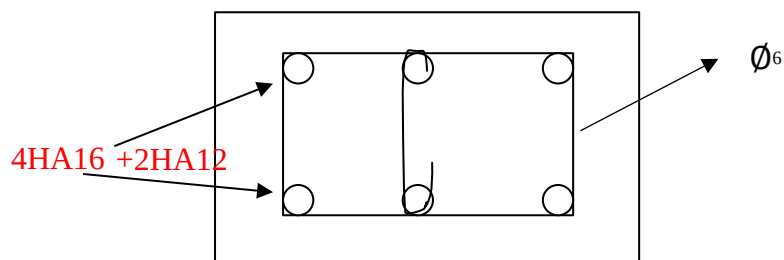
Ferrailage de la section du poteau en compression selon le code CBA
